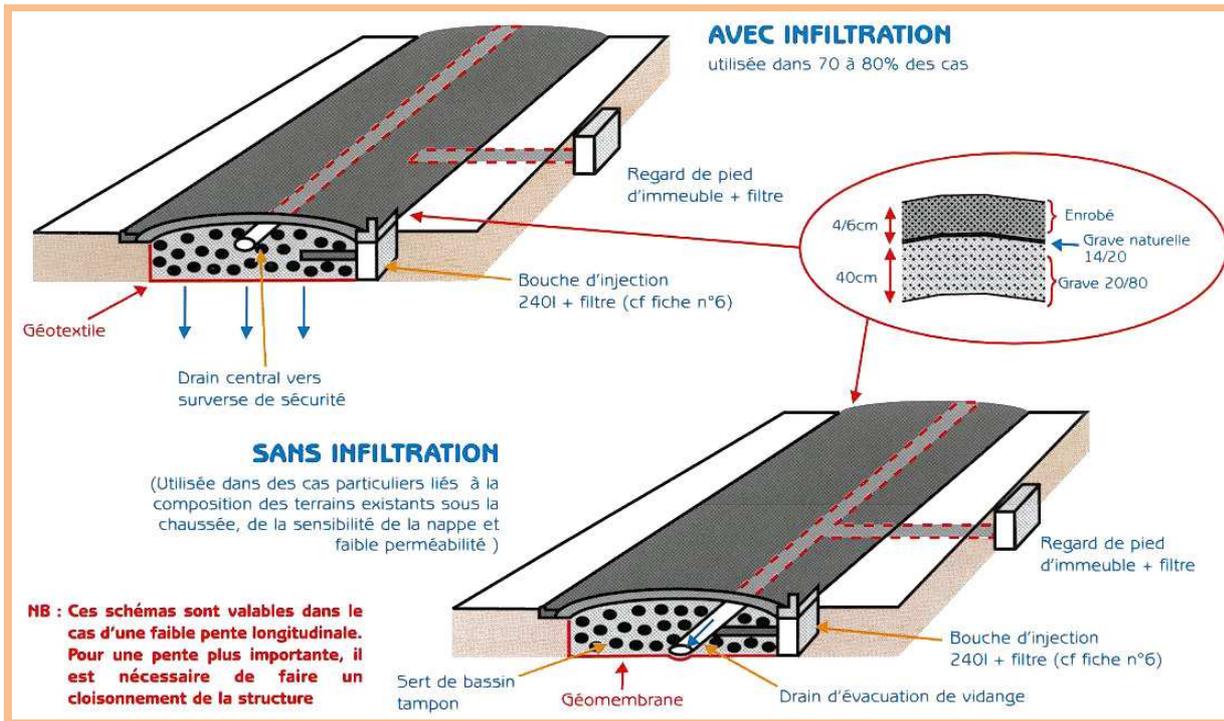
Coupe transversale d'une chaussée à structure réservoir avec revêtement étanche (Injection localisée)¹
